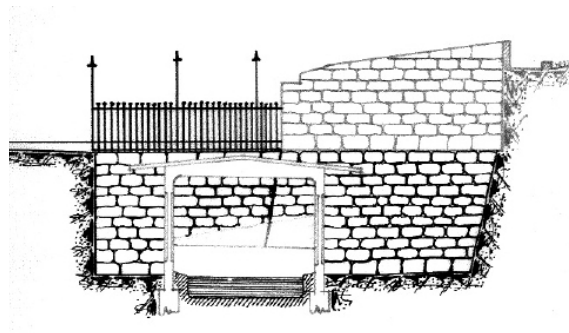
Corte do lavadouro da Presa Velha, depois da intervenção.
